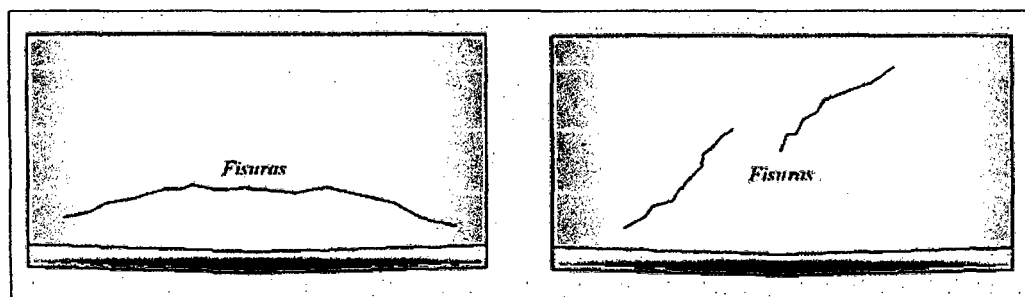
14. Fisuración en muros por deformación excesiva. Fuente: (Stuardo P., 2008)
